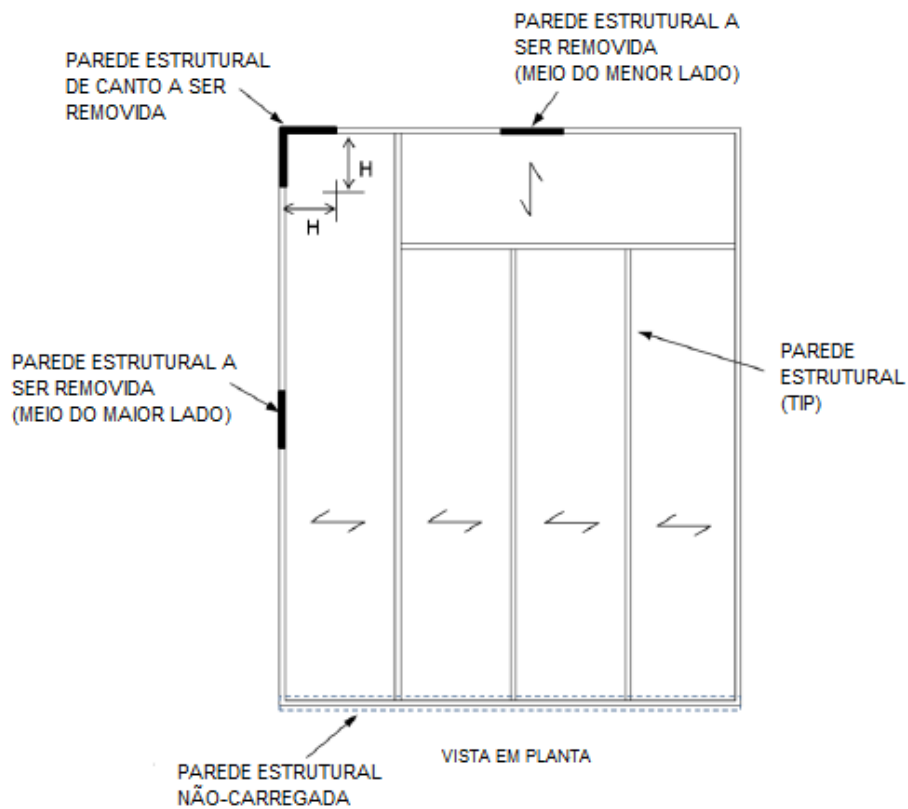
Locais de remoção das paredes estruturais externas (adaptado de GSA, 2013)
